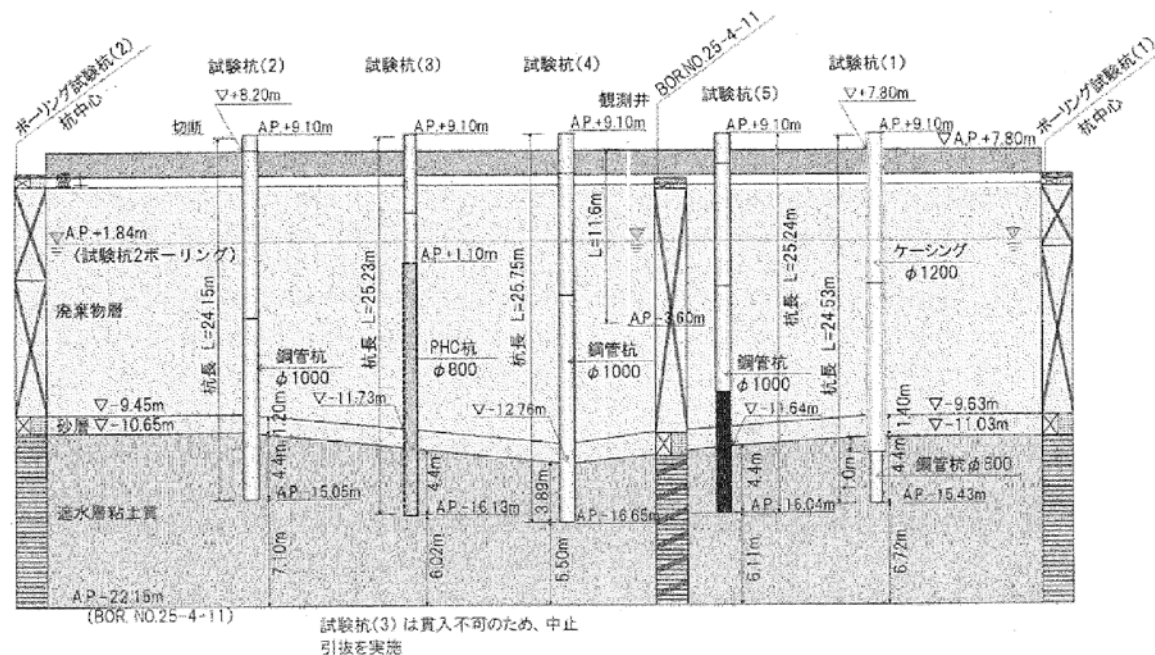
試験杭の施工条件。実際の施工位置に対応して描いているため、試験杭の順番に注意
